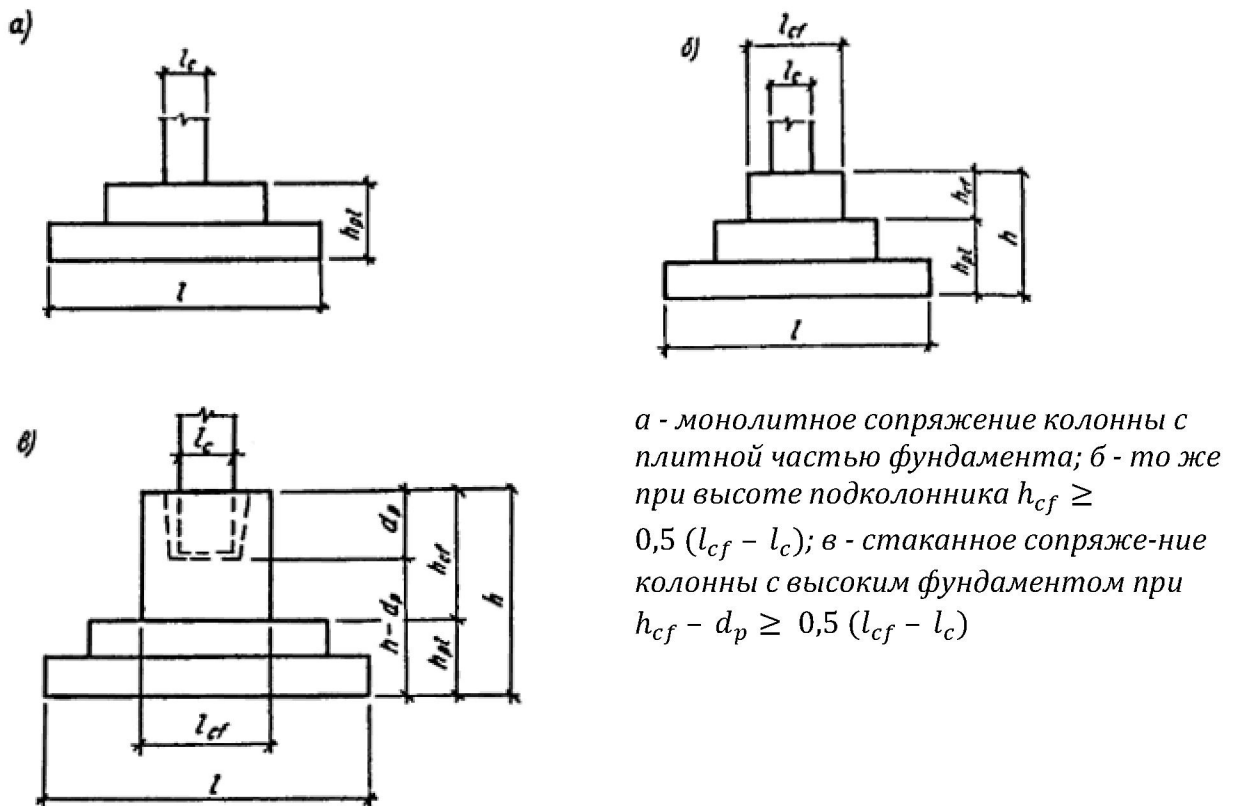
Виды сопряжений фундамента с колонной по 1-й схеме расчета на продавливание [64]
